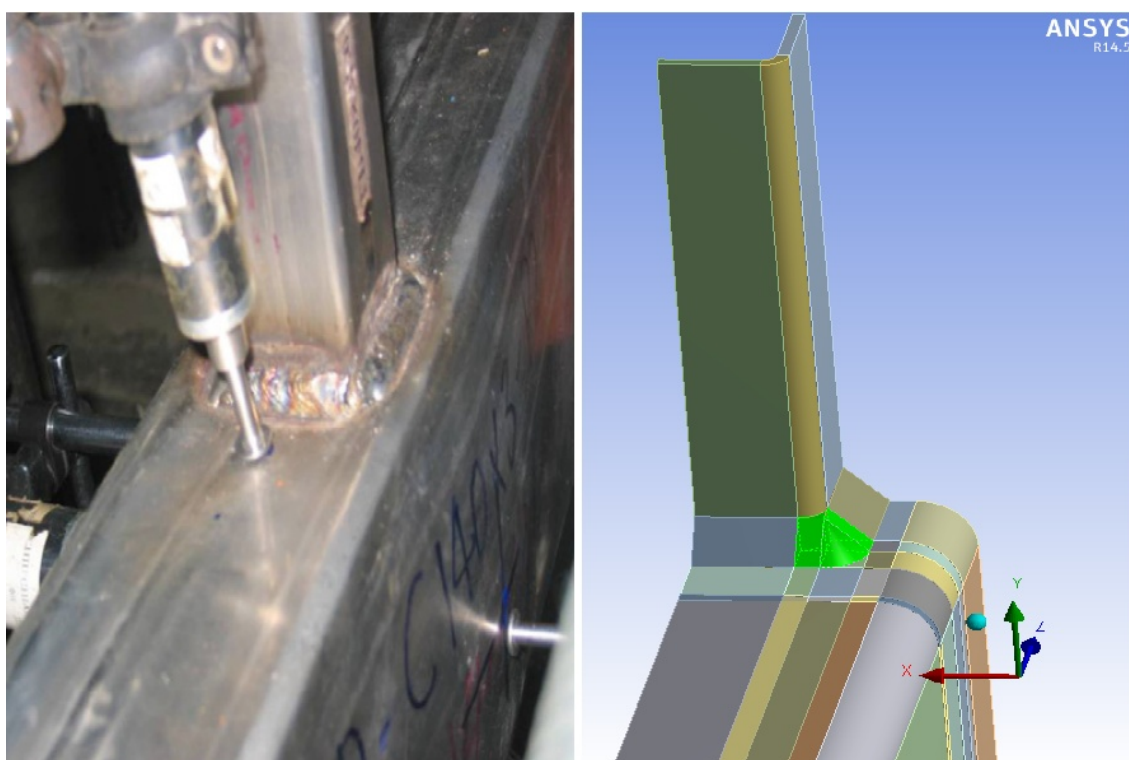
Modelo 2. Soldadura ensayo experimental (izquierda) / nuevo modelo de soldadura (derecha)
